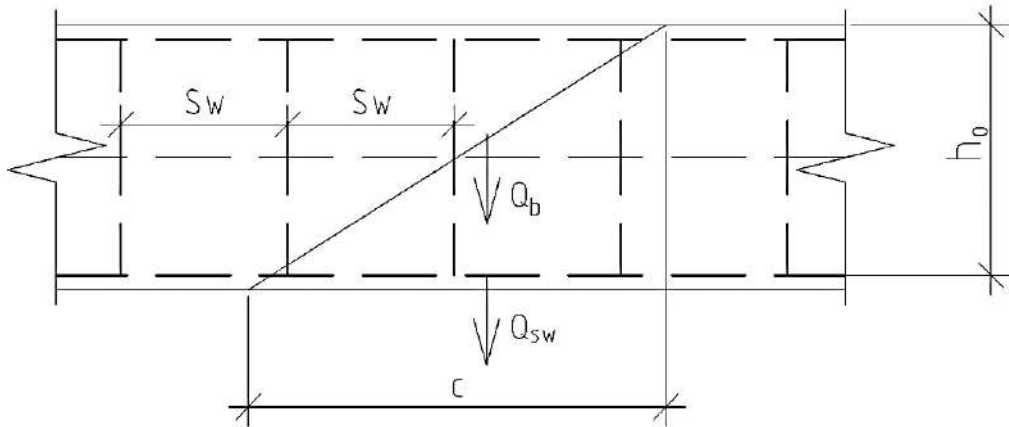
Розрахункова схема зусиль похилого перерізу за методом[46]
